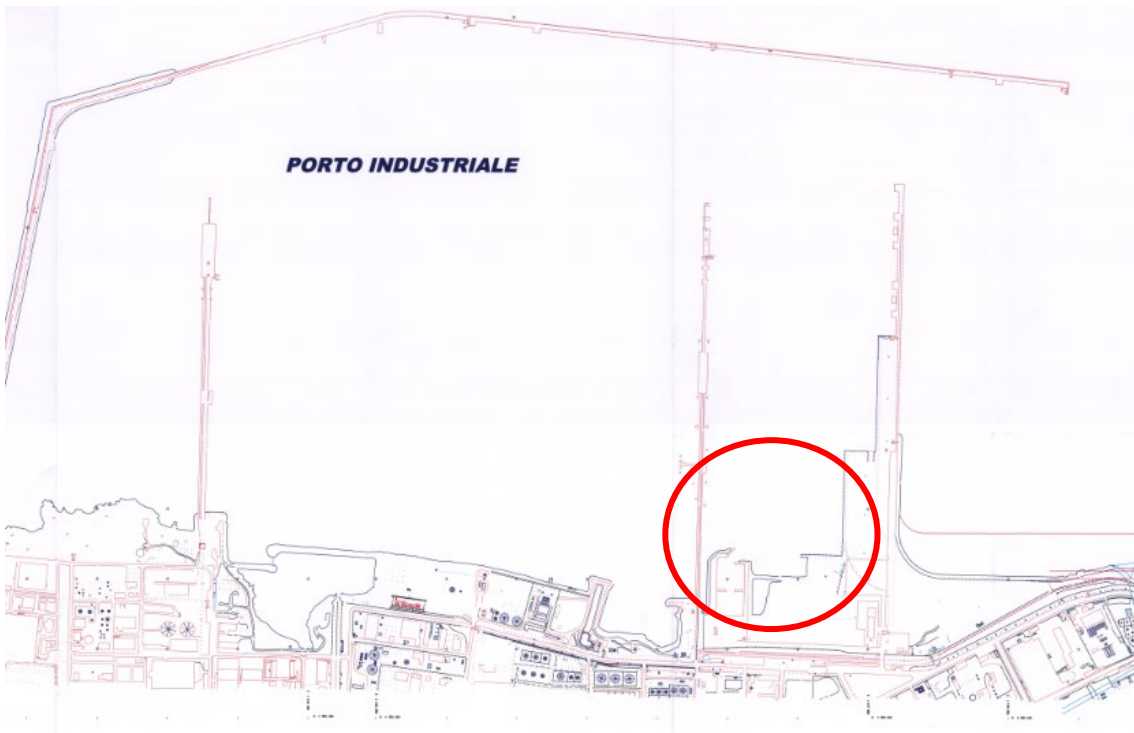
stralcio planimetria PRP vigente con indicazione area di intervento
